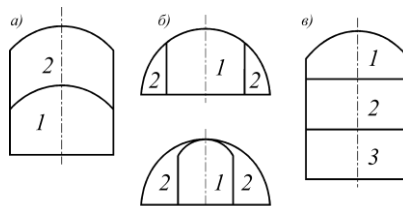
Послідовність розкриття перерізу тунелю при уступному методі проходження: а – спосіб верхнього уступу; б – спосіб бічного уступу; в – спосіб нижнього уступу
